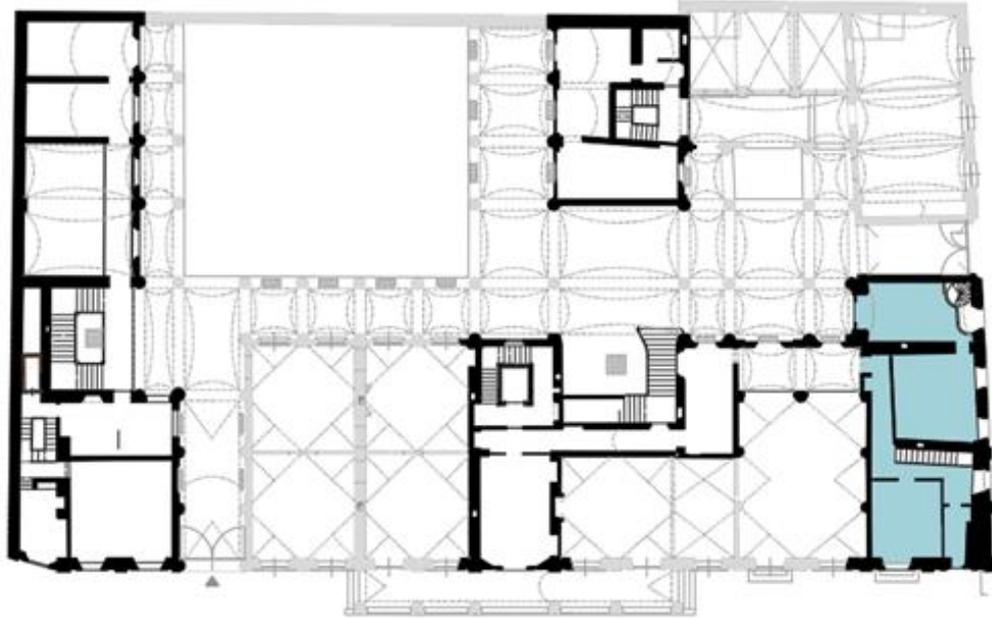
Pianta del Piano ammezzato. Area di distribuzione della UTA 2.
